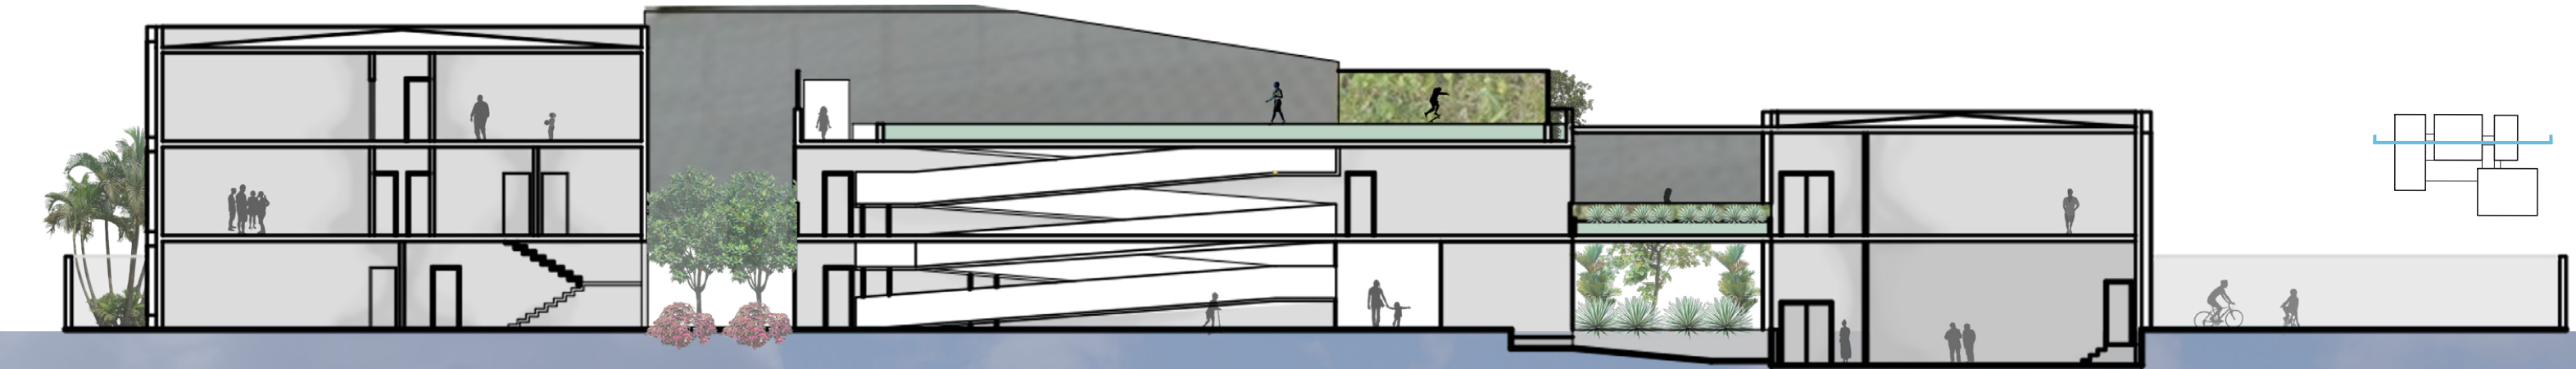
VISTA EXTERNA, ELEVÇÃO NOROESTE
